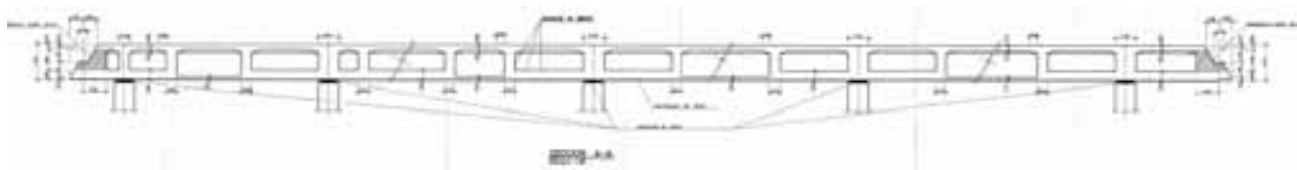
Sección tipo de la losa tomada de los planos del proyecto "as built"
